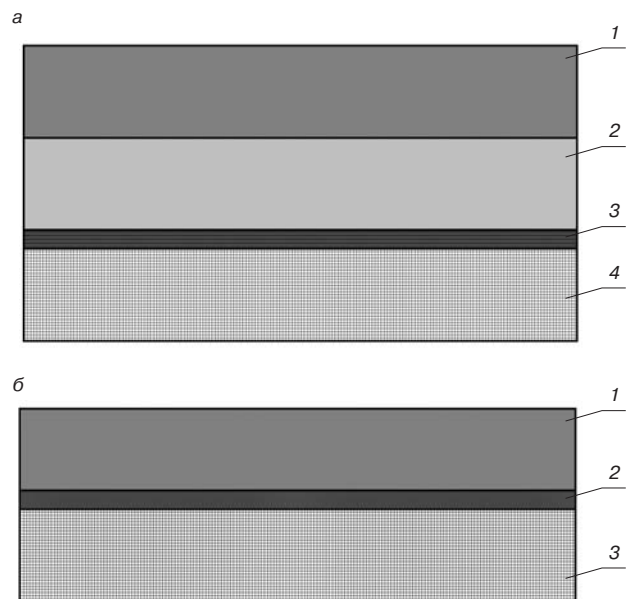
Конструкции дорожной одежды мостового полотна, рекомендуемые к применению на железобетонной плите В: с покрытием из литой сероасфальтобетонной смеси: а – проезжая часть: 1 – литой сероасфальтобетон I типа, слоем 40 мм; 2 – асфальтобетон типа А, Б или литой сероасфальтобетон I типа, слоем 40 мм; 3 – рулонный гидроизоляционный материал; 4 – железобетонная плита; б – тротуар: 1 – литой сероасфальтобетон II типа, слоем 30 мм; 2 – рулонный гидроизоляционный материал; 3 – железобетонная плита
